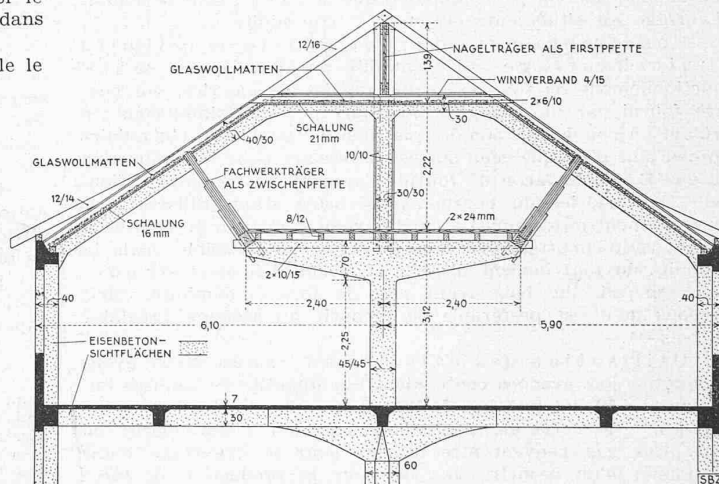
Schnitt des Dachstocks und Dachstuhls. — Masstab 1 : 120
